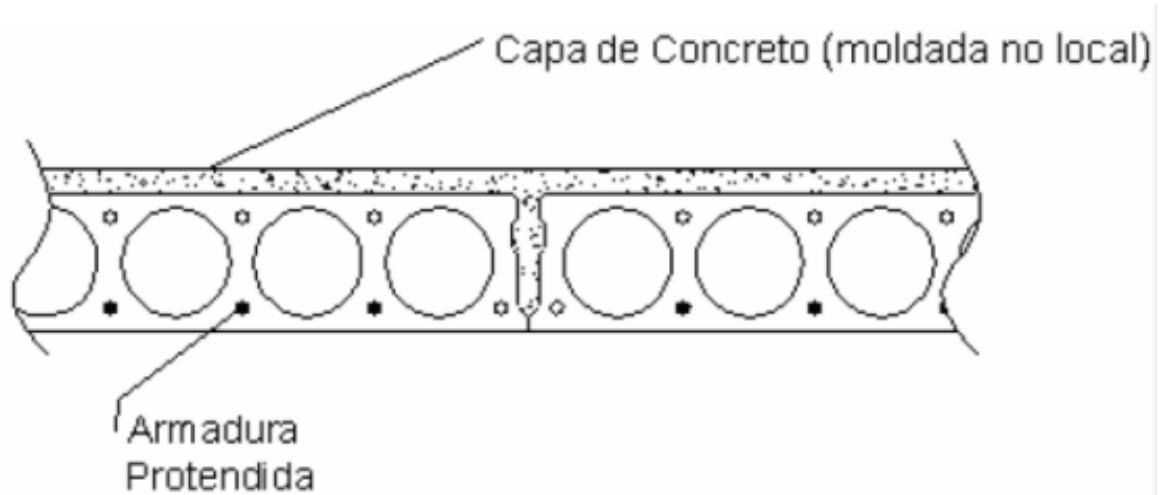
Laje alveolar com capa de concreto (Araújo, 2007)
